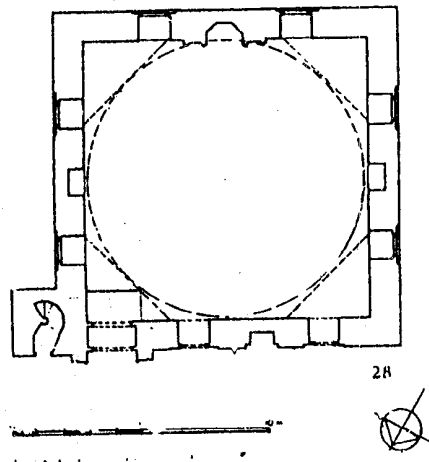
مسقط أفقي لجامع فيروز اغا في استانبول (عن : Goodwin)
